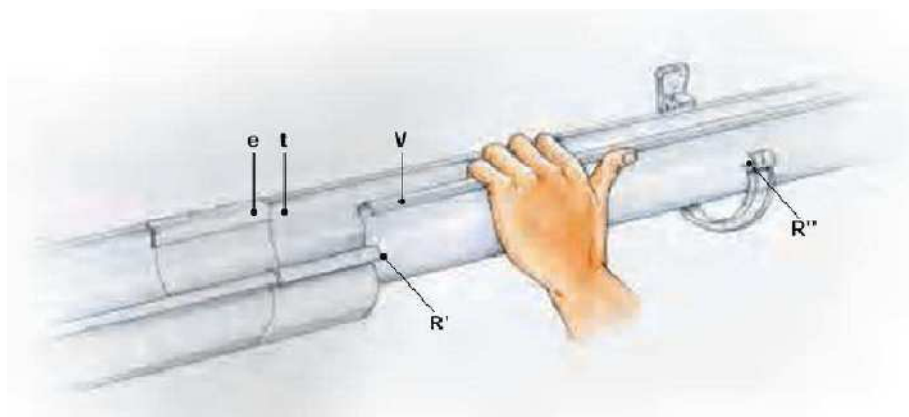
Imagen de canalón en alero de cubierta inclinada<sup>123</sup>
